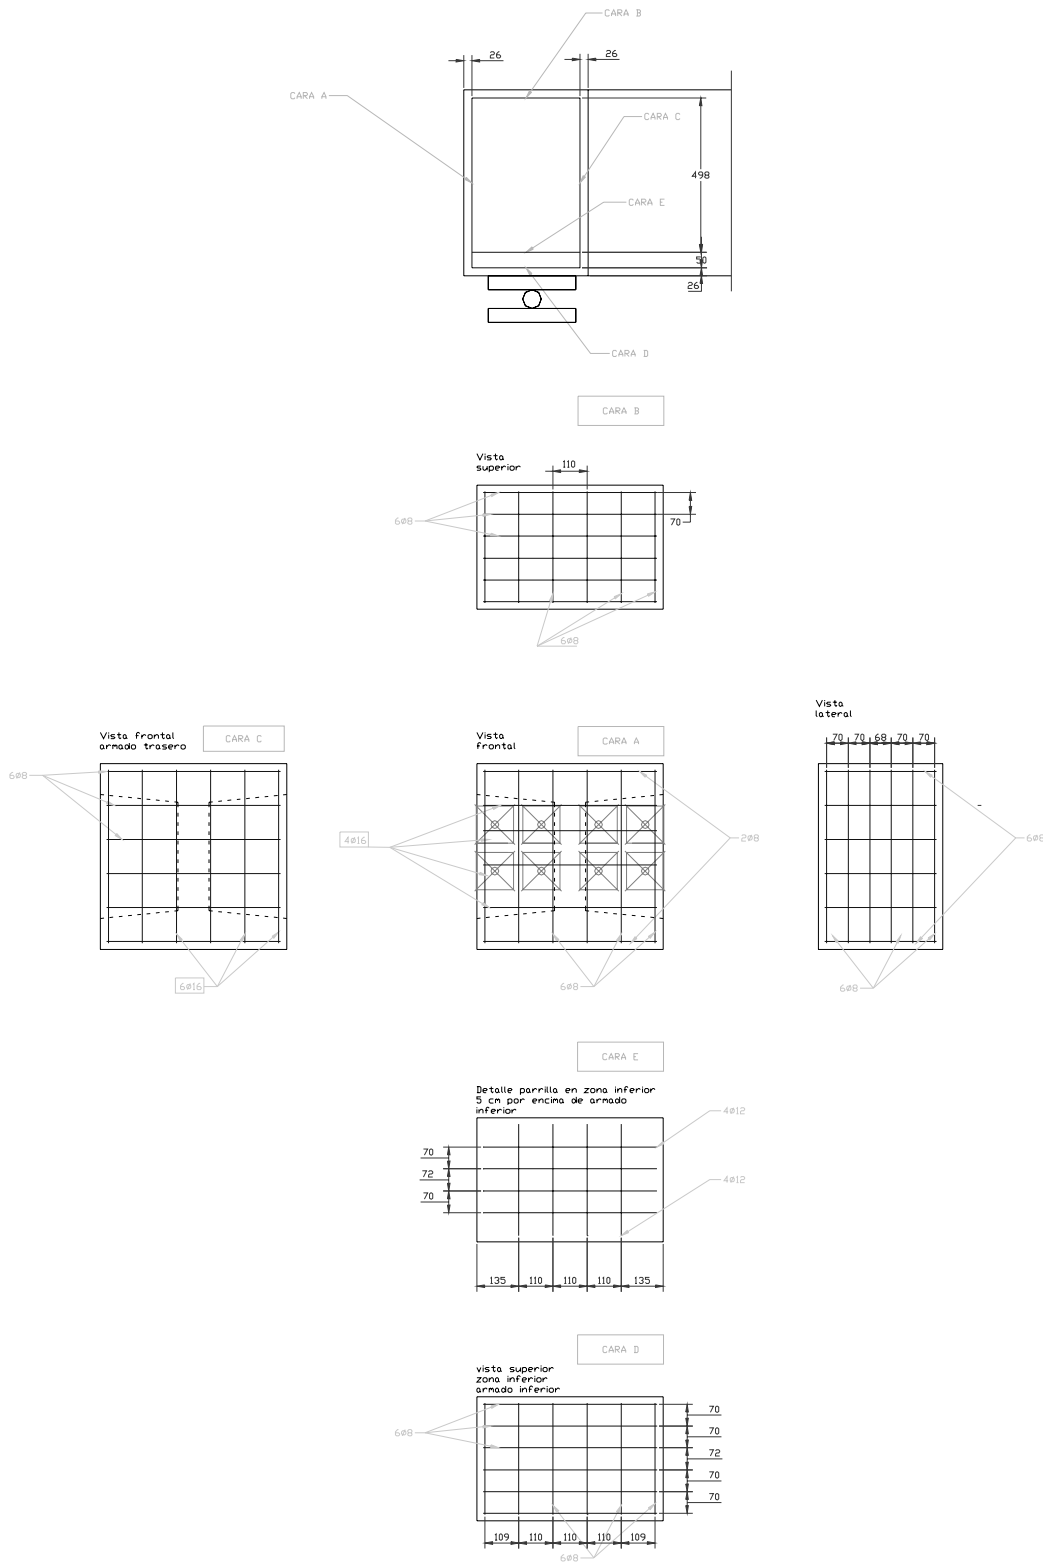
Armado de los anclajes. Dimensiones en mm.
